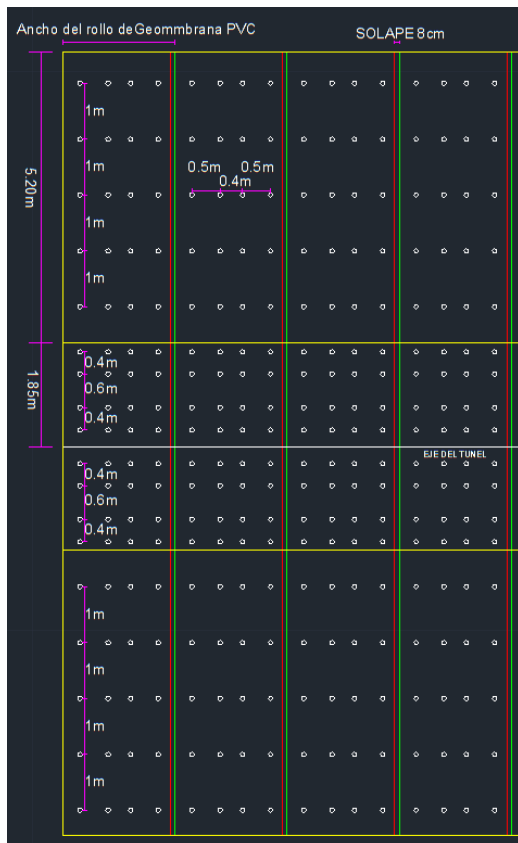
Sistema de fijación de la geomembrana PVC, vista en planta
